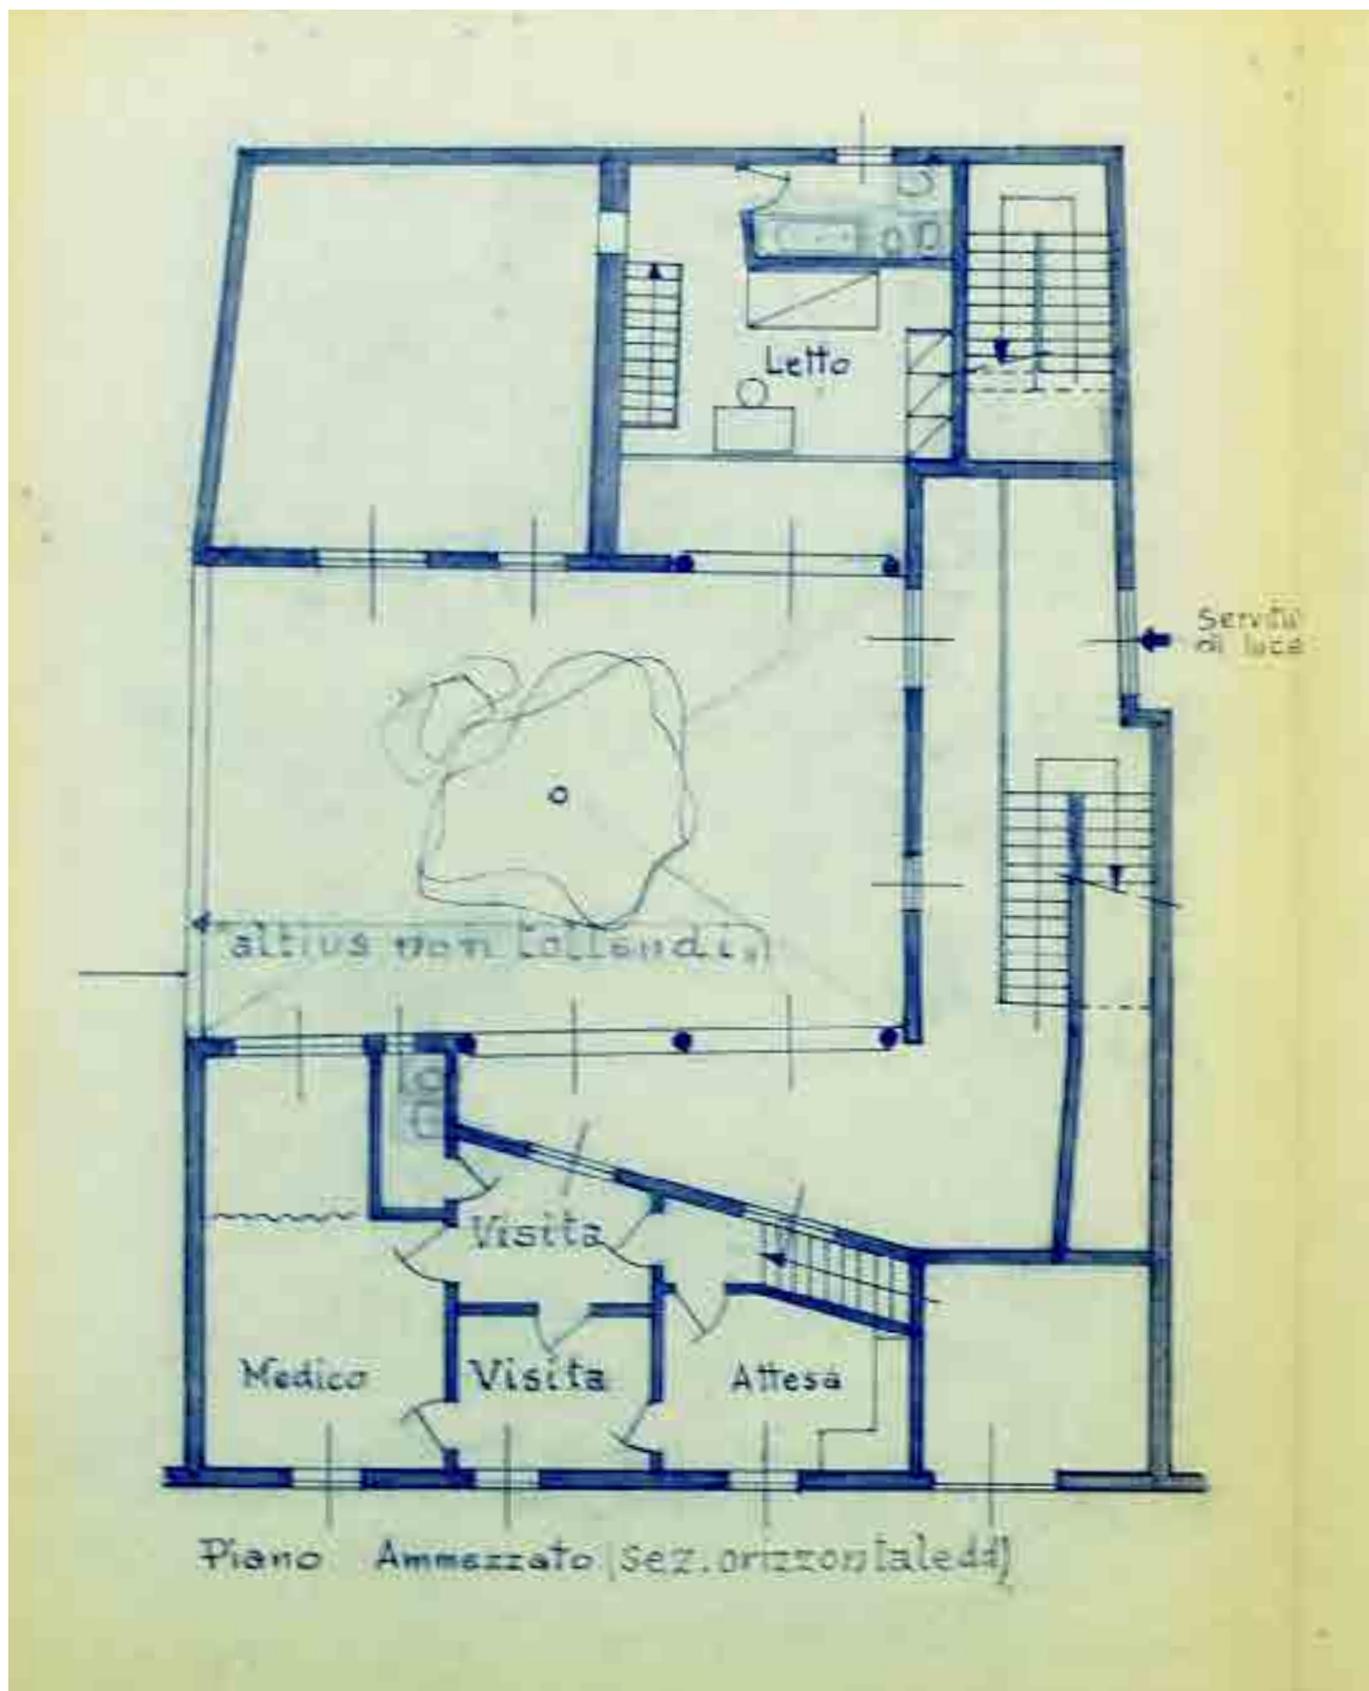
P. Bottoni, Planimetria del piano ammezzato di casa Loperfido (1967)
